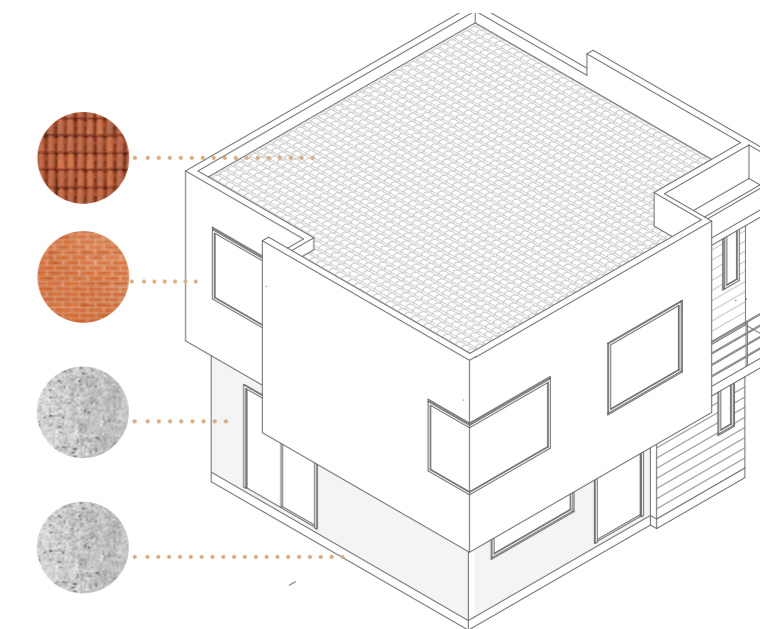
Elementos Constructivos, Adobes. Fuente: Autores, 2023
